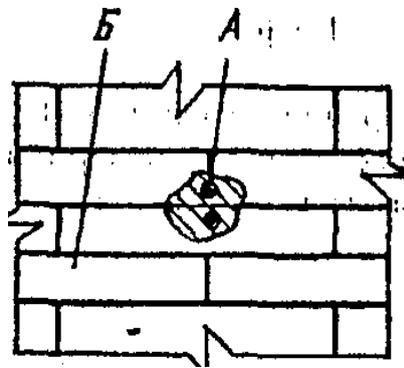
Коррозия А сварного шва, околошовной зоны, а также основного металла стенки Б на длине не более 500 мм.
